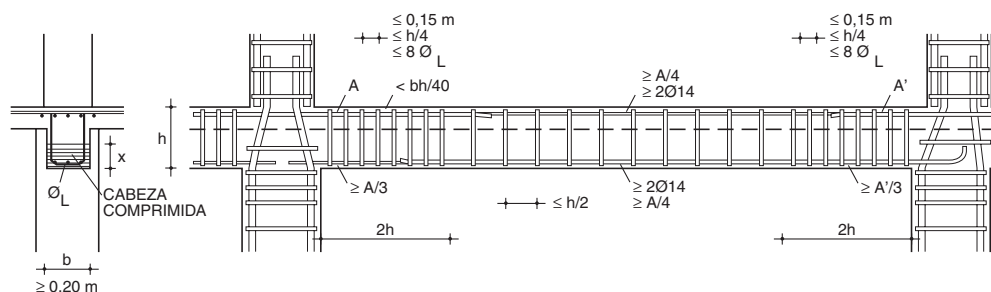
Requisitos de vigas para ductilidad alta ($\mu = 3$)
